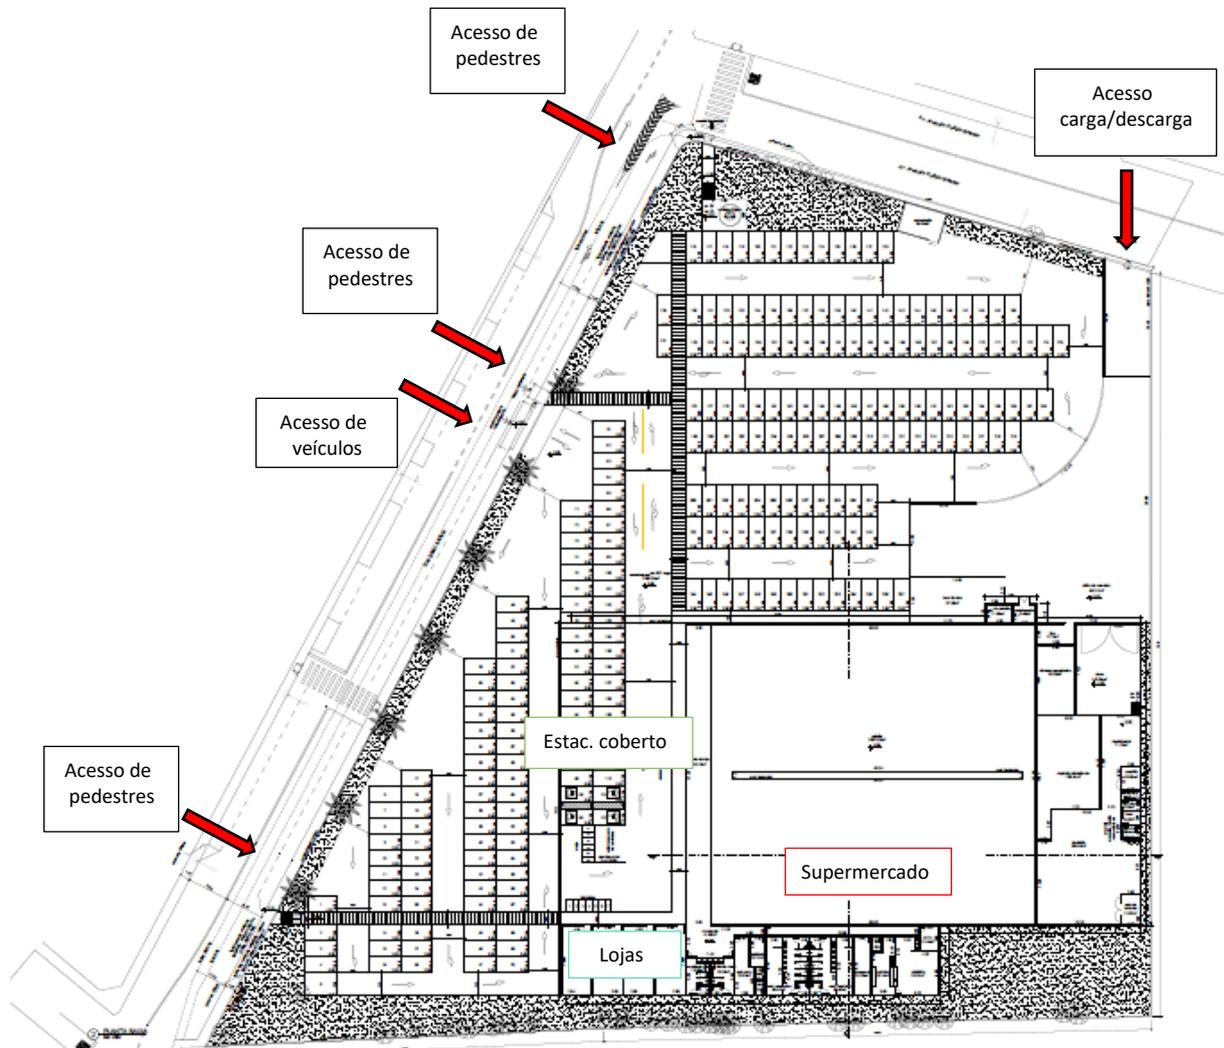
PLANTA DE IMPLANTAÇÃO DO EMPREENDIMENTO
